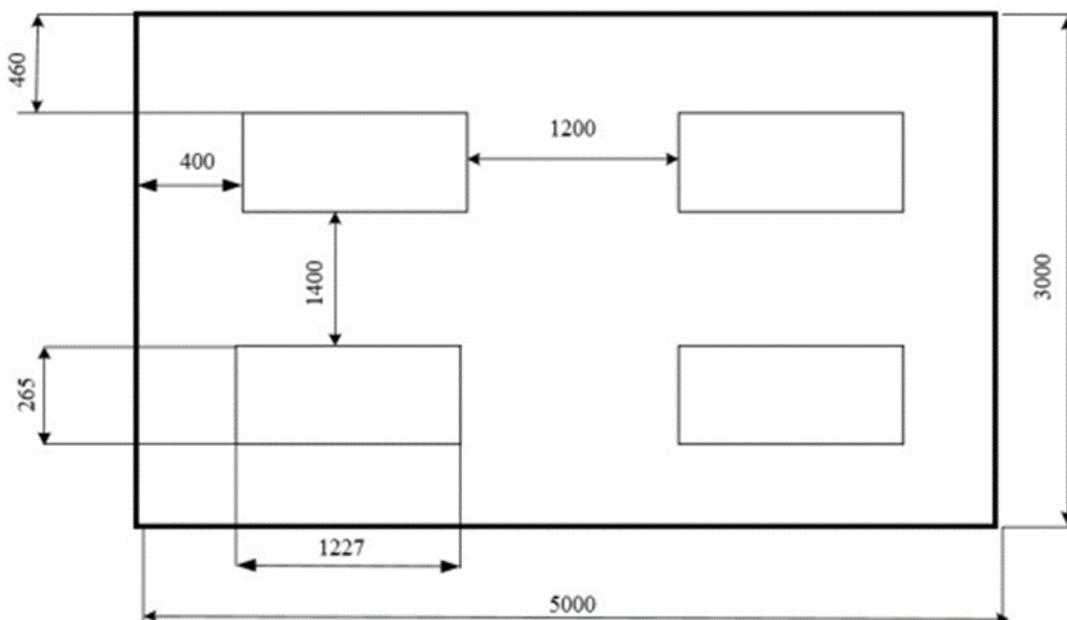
План помещения и размещения светильников с люминесцентными лампами
